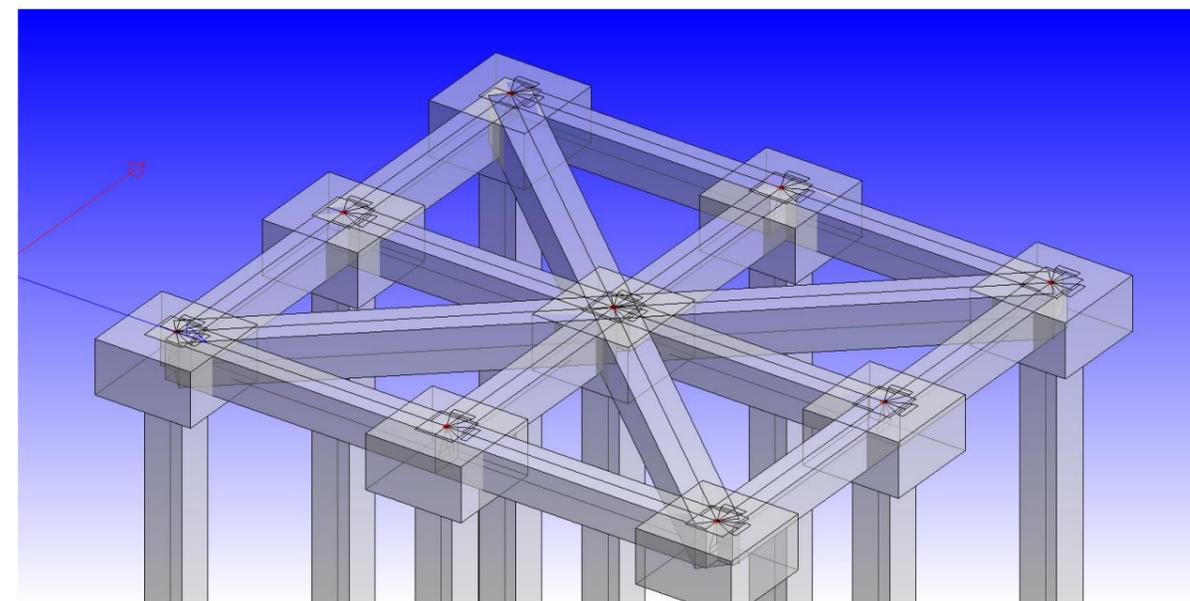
Encepado y pilotes de la obra de captación en el C.B.G. Cálculos estructurales
